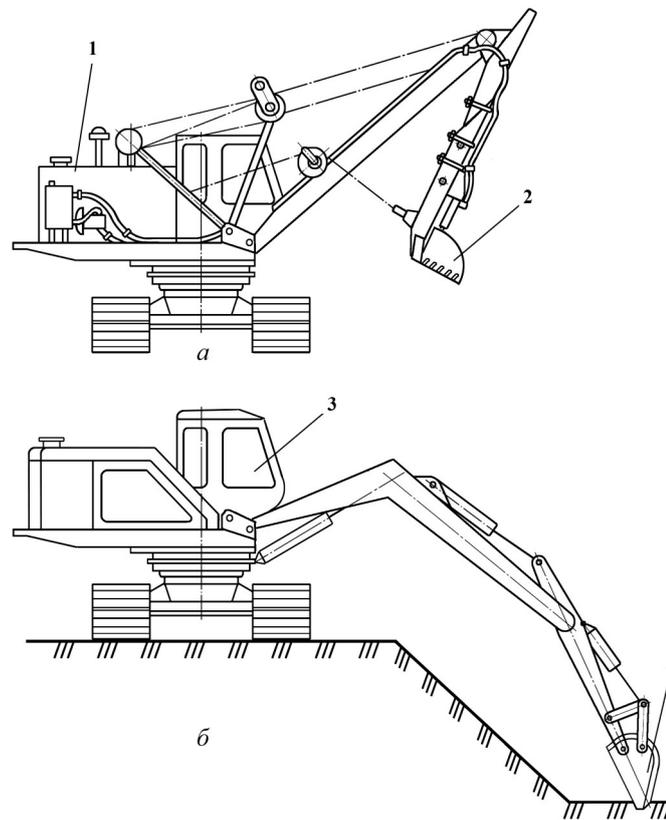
Схемы экскаваторов с поворотными циркульными ковшами конструкции БелНИИМуВХ
